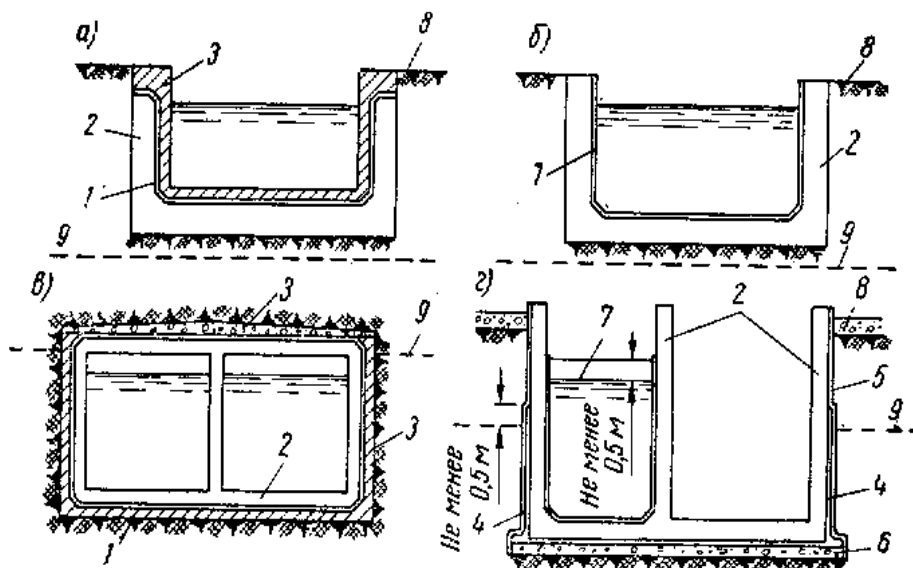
Гидроизоляция водонаполненных сооружений.
